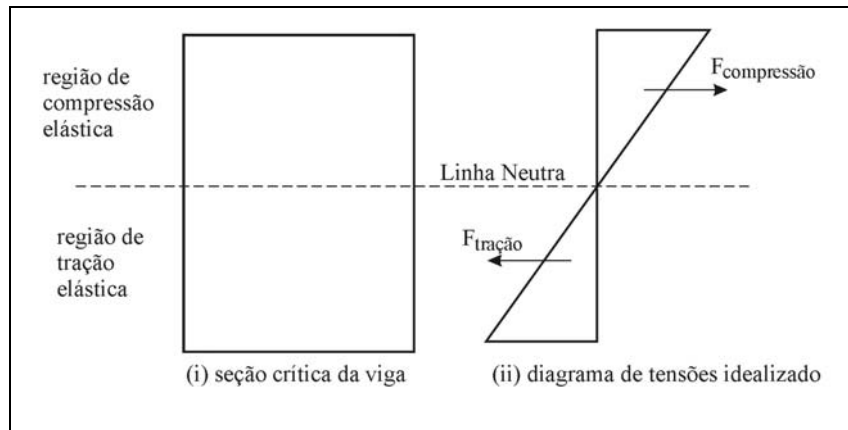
Representação esquemática da viga de concreto reforçado com fibras de aço sob o carregamento de flexão – Estágio 1: seção não fissurada (JONES, 1998).
